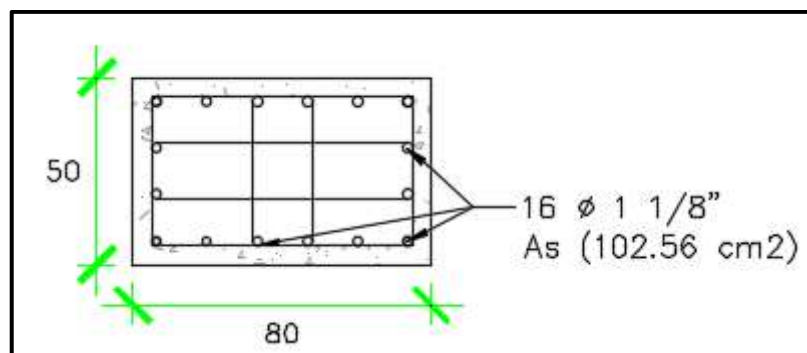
Distribución del acero vertical y transversal en la sección del pilar
